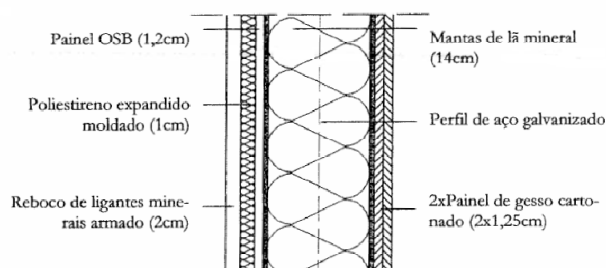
Parede com estrutura em perfis leves de aço [14]
